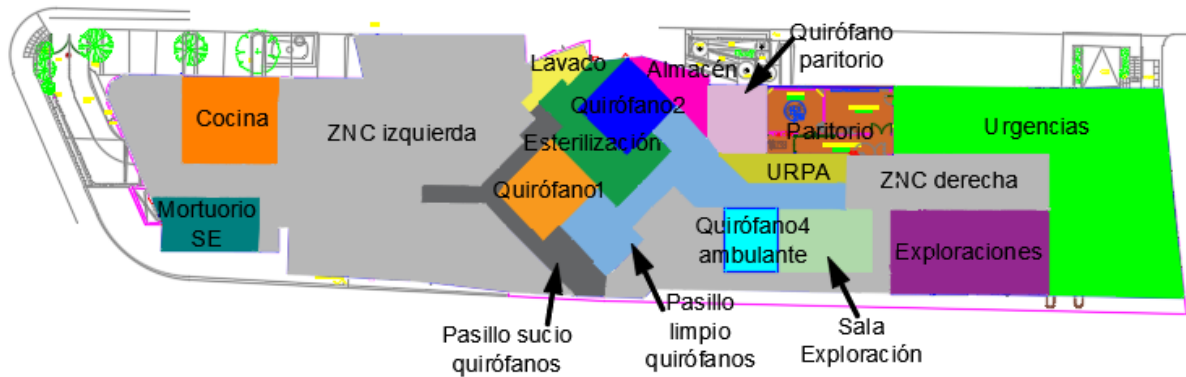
Anexo I. Zonificación planta -1 (fuente: elaboración propia).
